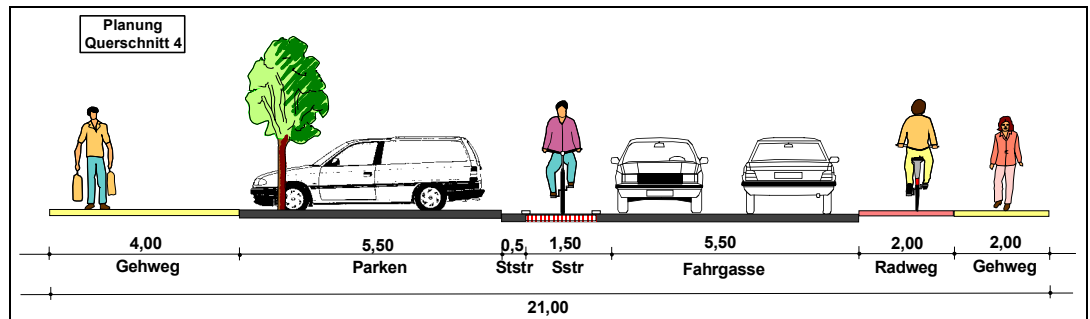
Elsässer Straße – Planung Abschnitt 4
